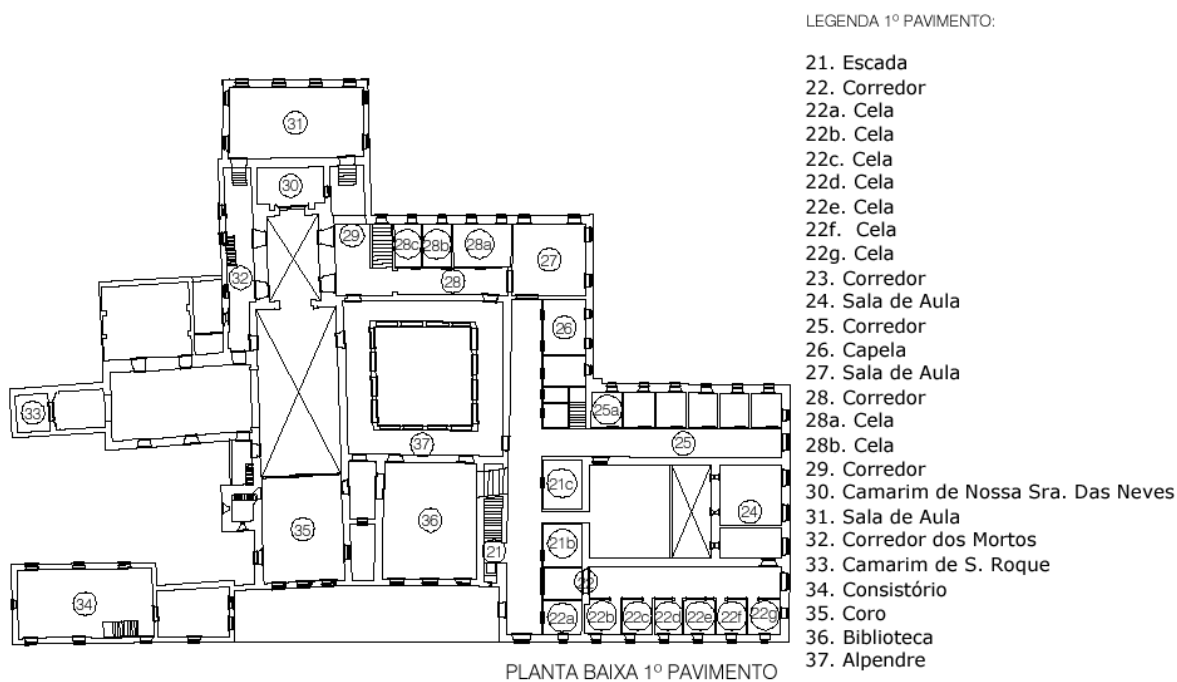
Planta baixa do primeiro piso do convento de São Francisco de Olinda. Esquema do arquivo pessoal de Bartira Barbosa.
